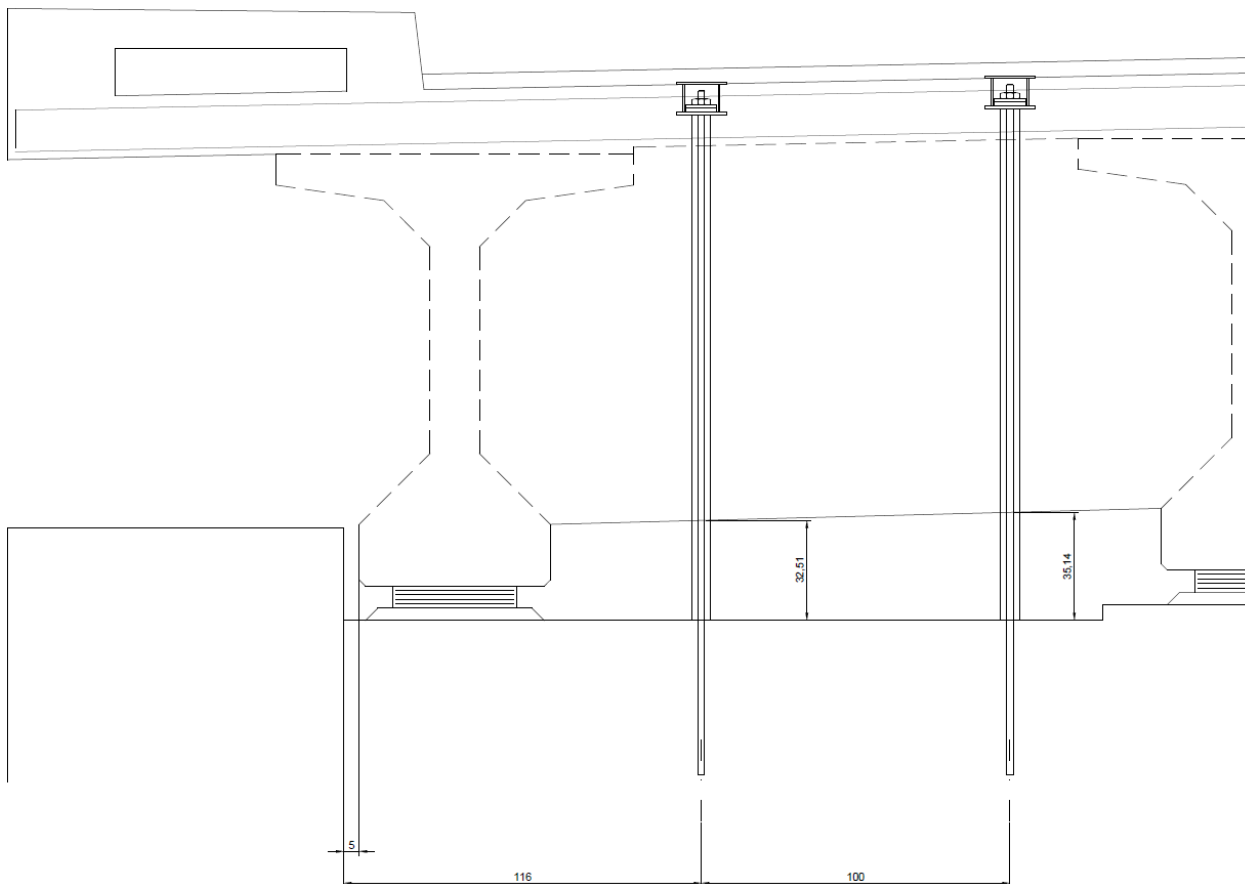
Detalle de Travesaño con Barras Sísmicas y Elastómeros en Puente Águila Norte.
